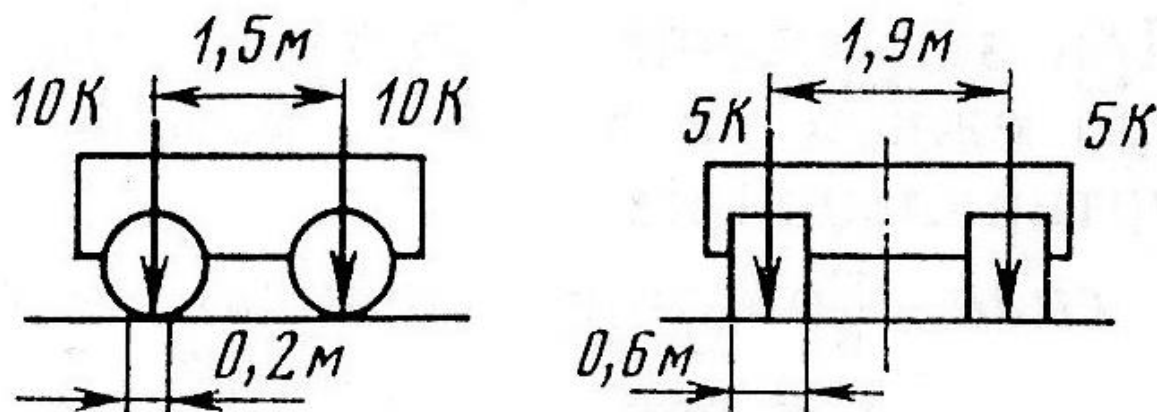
Схема нагрузки от тележки подвижной нагрузки АК для испытаний ДШ
